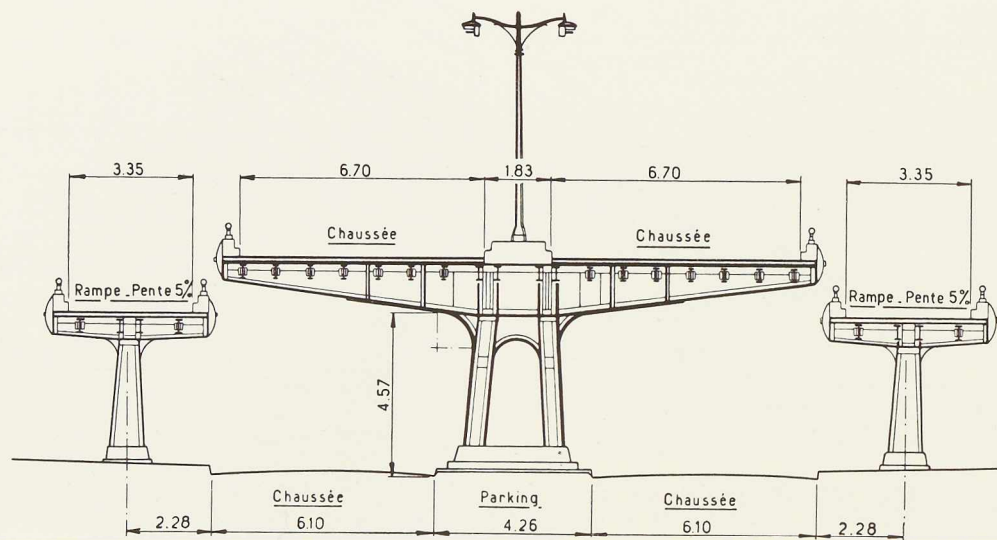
Coupe transversale du projet des ingénieurs-conseils Hazelet et Erdal, au droit des rampes d'accès et de départ; on notera la disposition avec porte-à-faux des trois voies.
